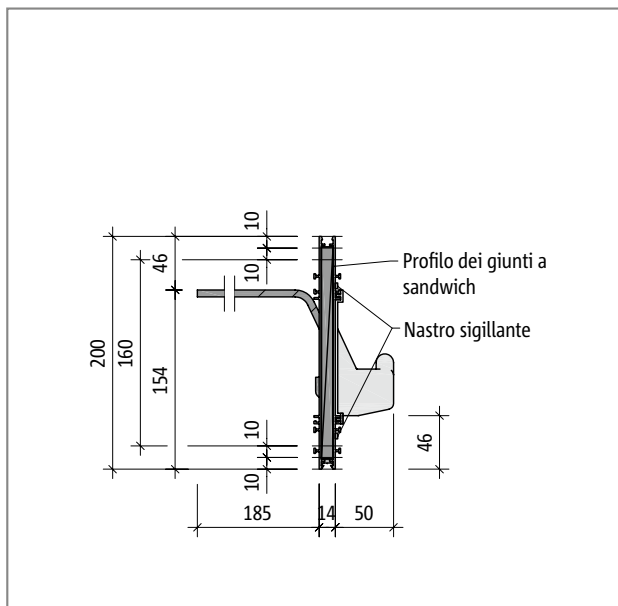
Schöck Tronsole® tipo T, sezione dell'elemento con profili dei giunti a sandwich nella versione base
